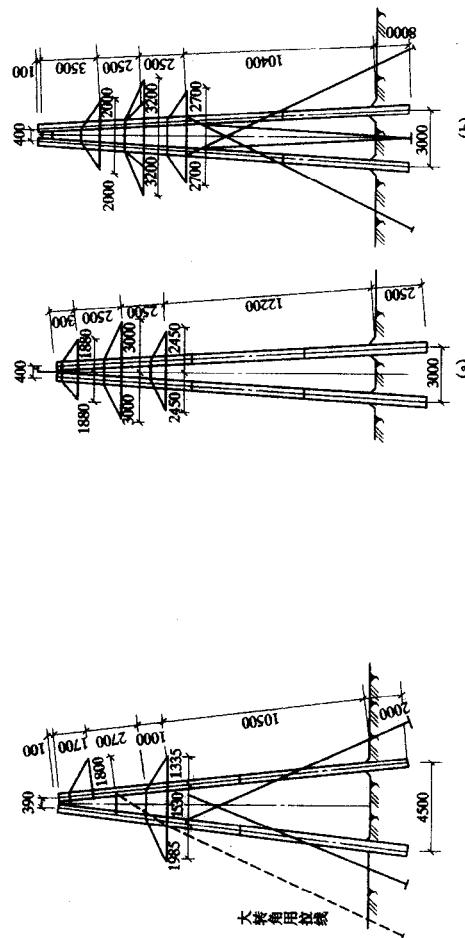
35~110kV 钢筋混凝土 A 型承力电杆
